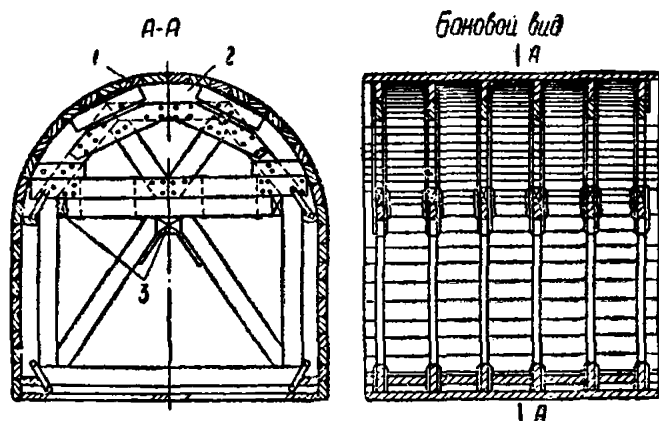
Стационарная опалубка на опорных конструкциях галерей и водоводов постоянного сечения со сводчатым перекрытием
